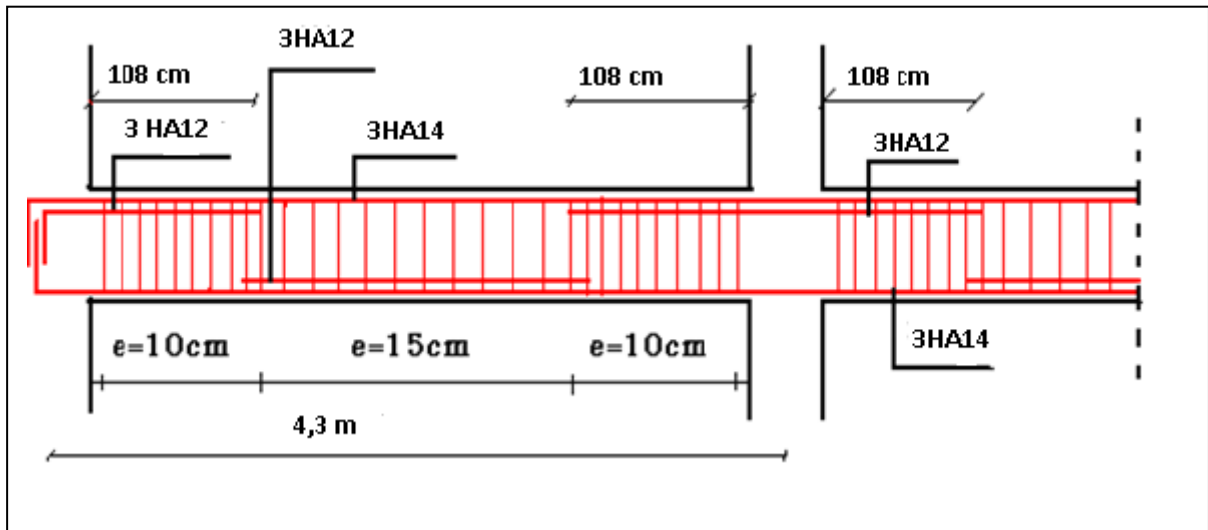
Exemple de dispositions constructives de la poutre principale.
